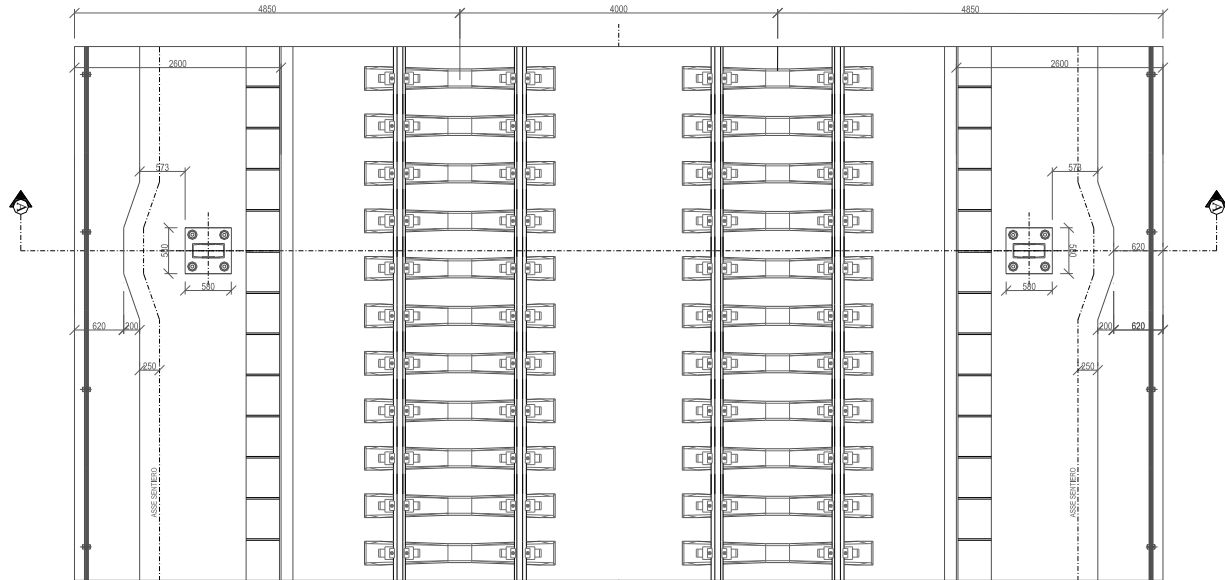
Stralcio planimetrico sezione tipo ferroviaria ponte a doppio binario
